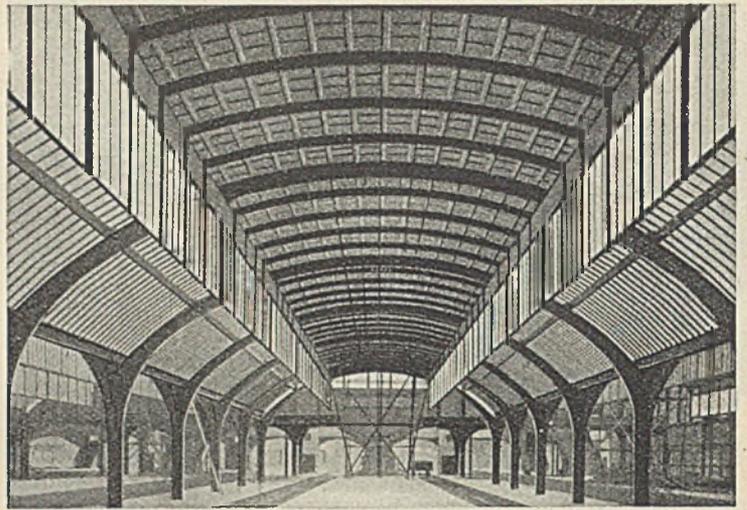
Längsbahnsteighalle zu Darmstadt.
